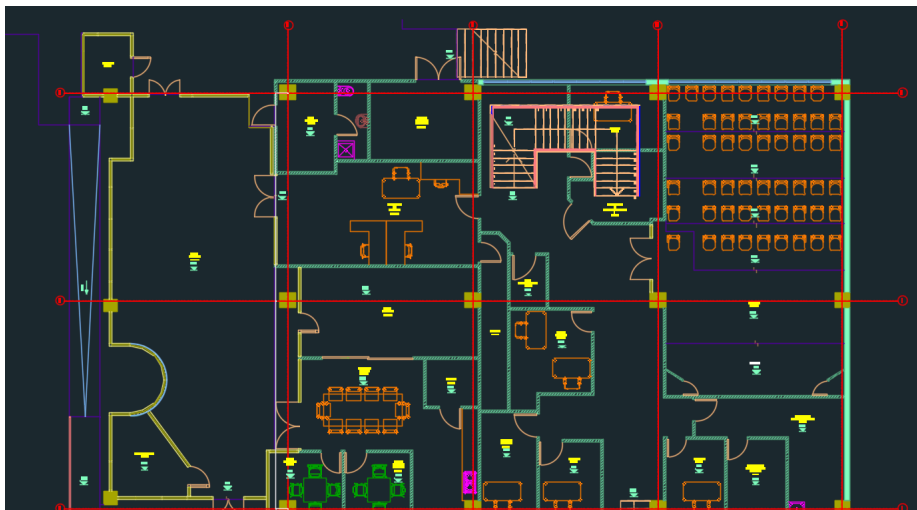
"Planimetría Nivel Zócalo Facultad de Farmacia de la UV"
